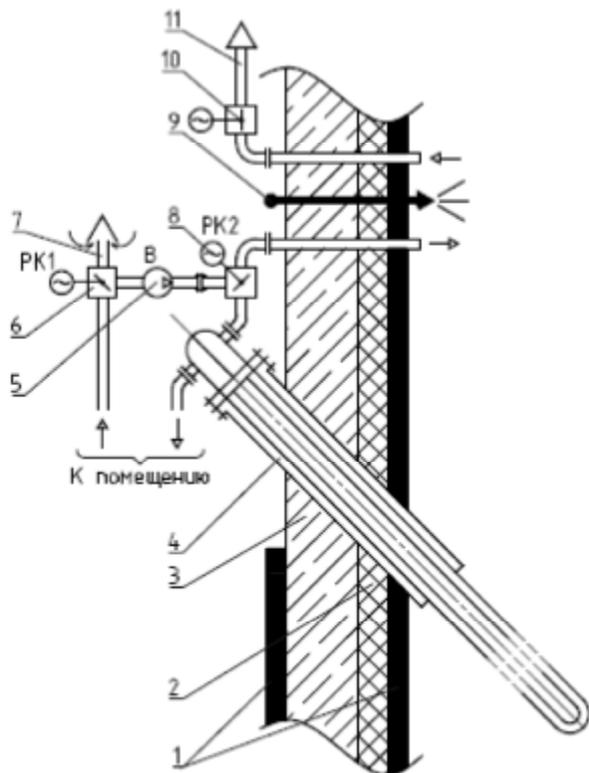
Установка оборудования на резервуаре: 1 – гидроизоляция; 2 – теплоизоляция; 3 – стенка резервуара; 4 – теплообменный пучок из U-образных труб; 5 – вентилятор; 6 – распределительный клапан на всасе вентилятора; 7 – воздушозаборное устройство; 8 – распределительный клапан на выходе вентилятора; 9 – форсунка; 10 –
